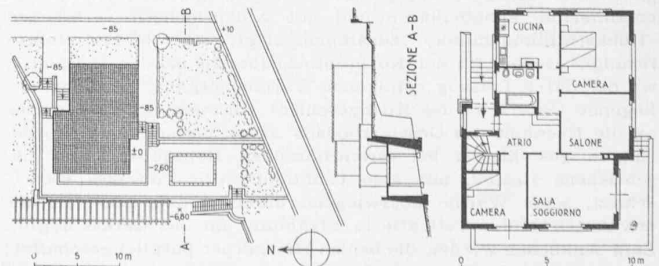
Lageplan 1 : 800, Schnitt und Grundriss 1 : 400
